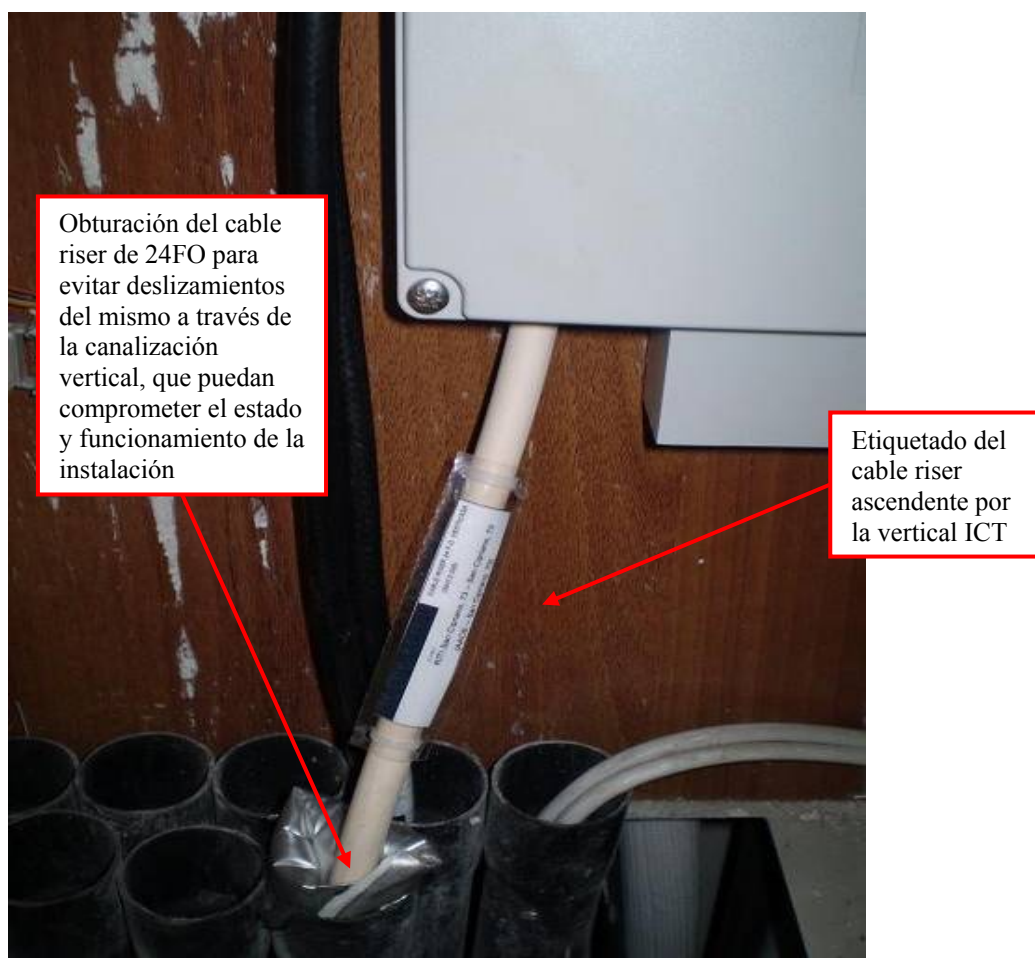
Vista tubos PVC de la canalización ICT del edificio para paso de cables en planta ático
